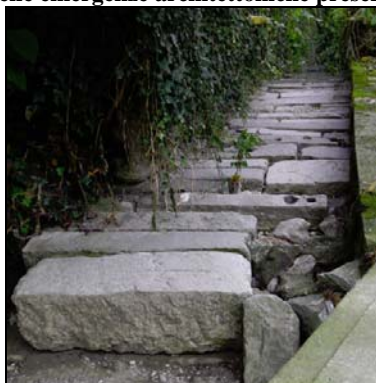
particolare (vista frontale) del muretto in pietra di protezione spondale di cui sopra. L'intervento ne prevede il mantenimento e la sua sistemazione.
